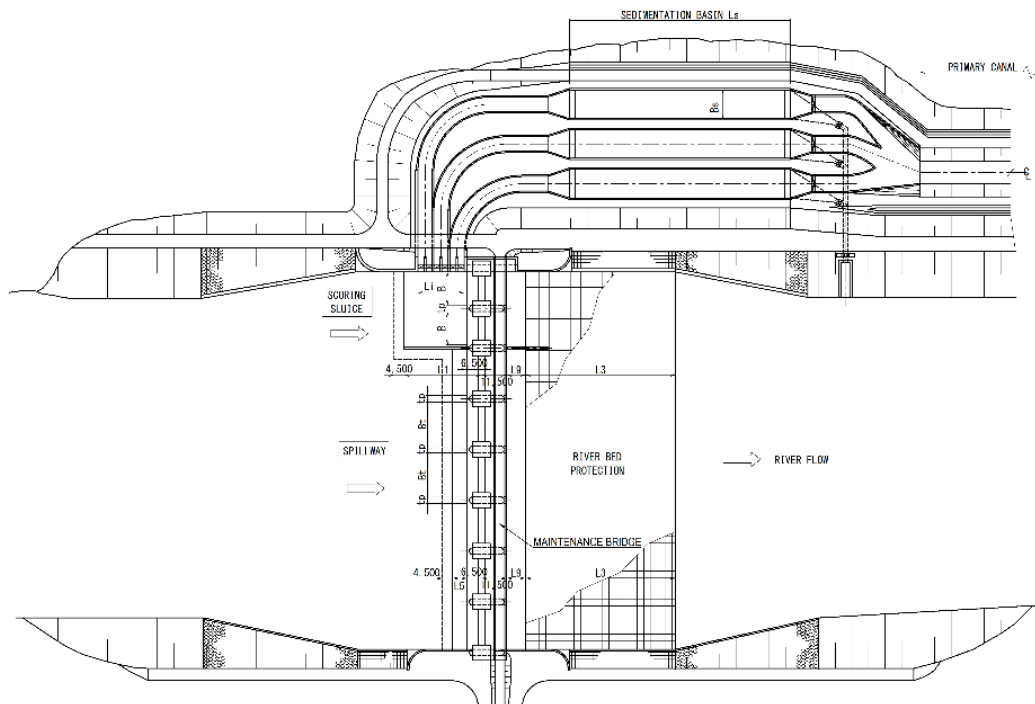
堰の一般平面図 (KT-3 地区取水工の例)
